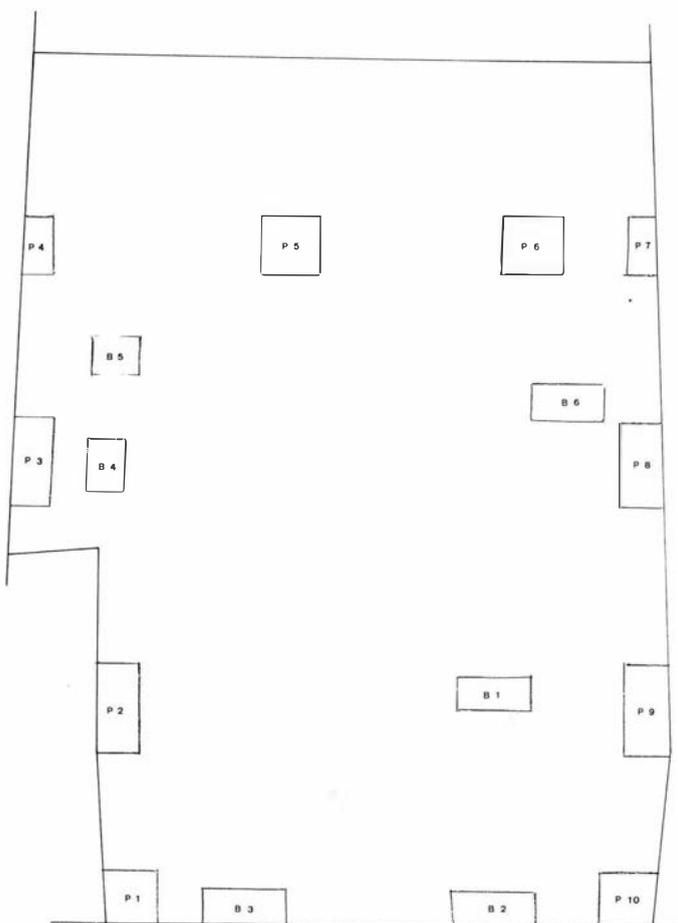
Planta del solar con la distribución de pozos y batches.
